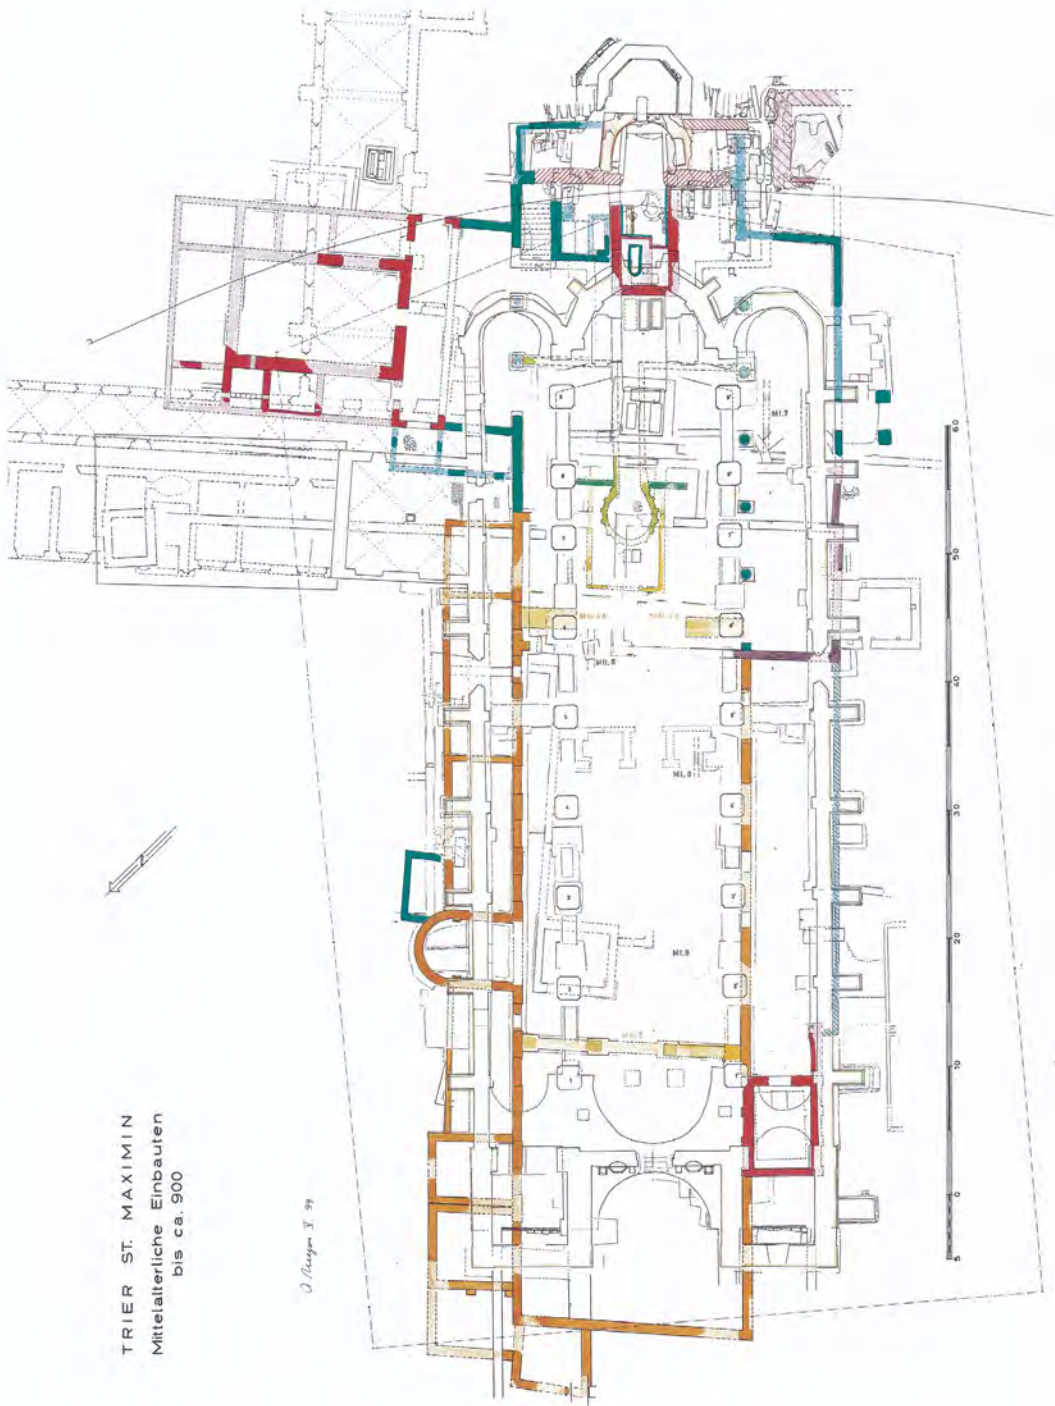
Trier, St. Maximin: Grundriss der antiken und mittelalterlichen Bauten.
